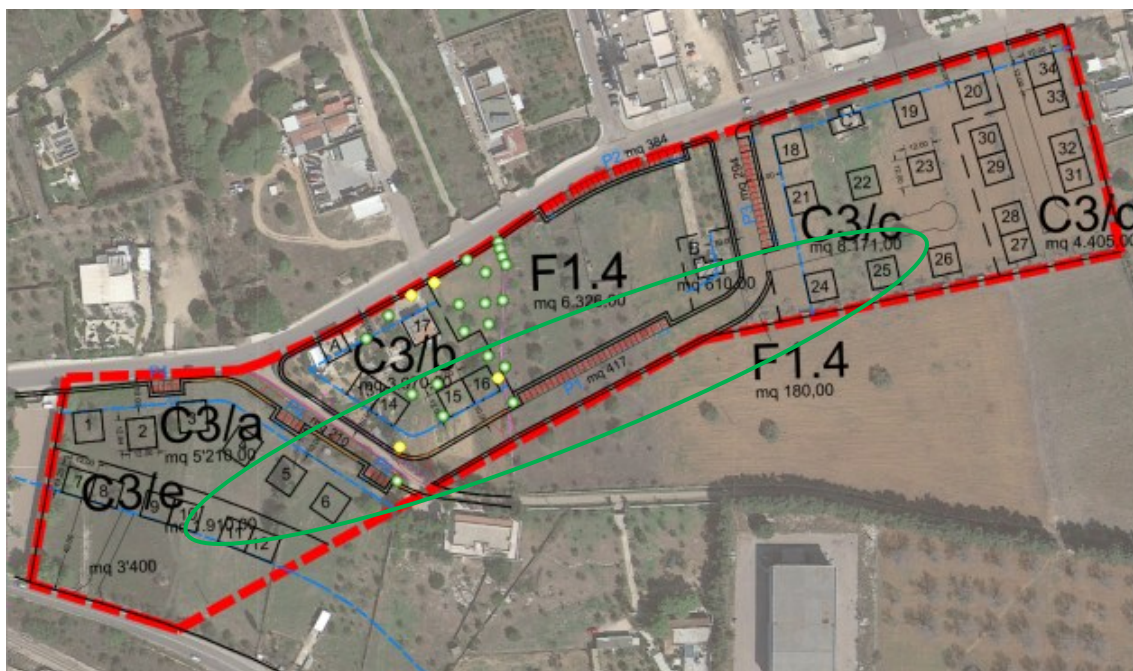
stralcio dell'ortofoto con indicazione dello spazio di transizione verso la campagna
